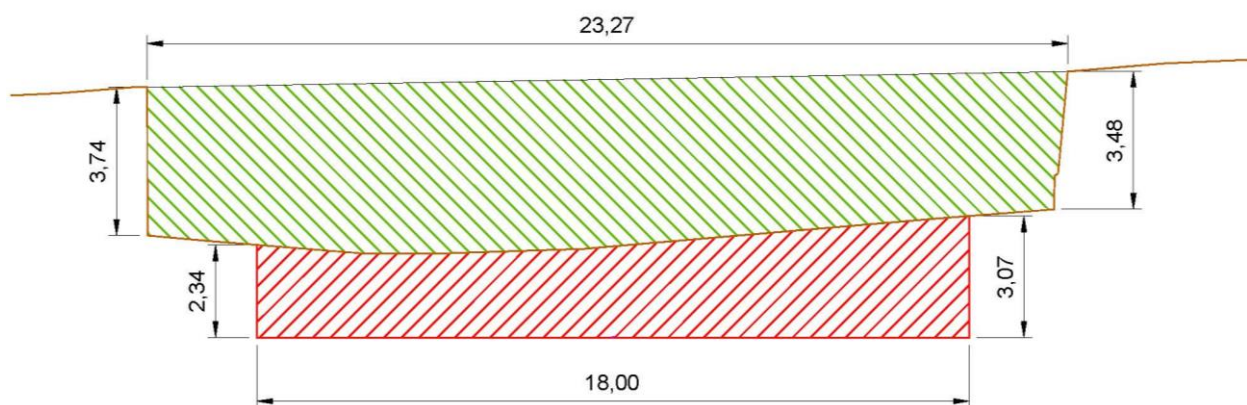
Croqui da seção transversal da estaca 86+0,000 (área em verde corresponde à calha existente e a área em vermelho à obra de aprofundamento do rio – medidas em metros).
